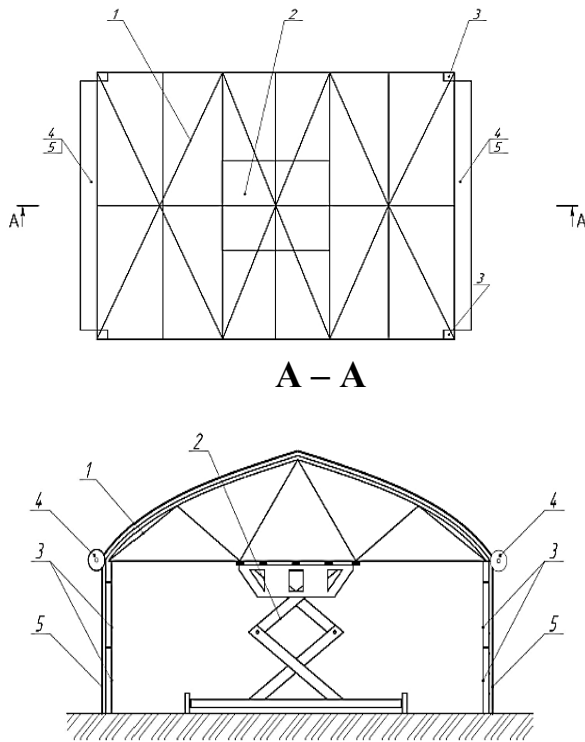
Схема площадки для монтажу плівкових теплиць: 1 – покриття; 2 – підйомник; 3 – опорні колони; 4 – рулон; 5 – плівка;
